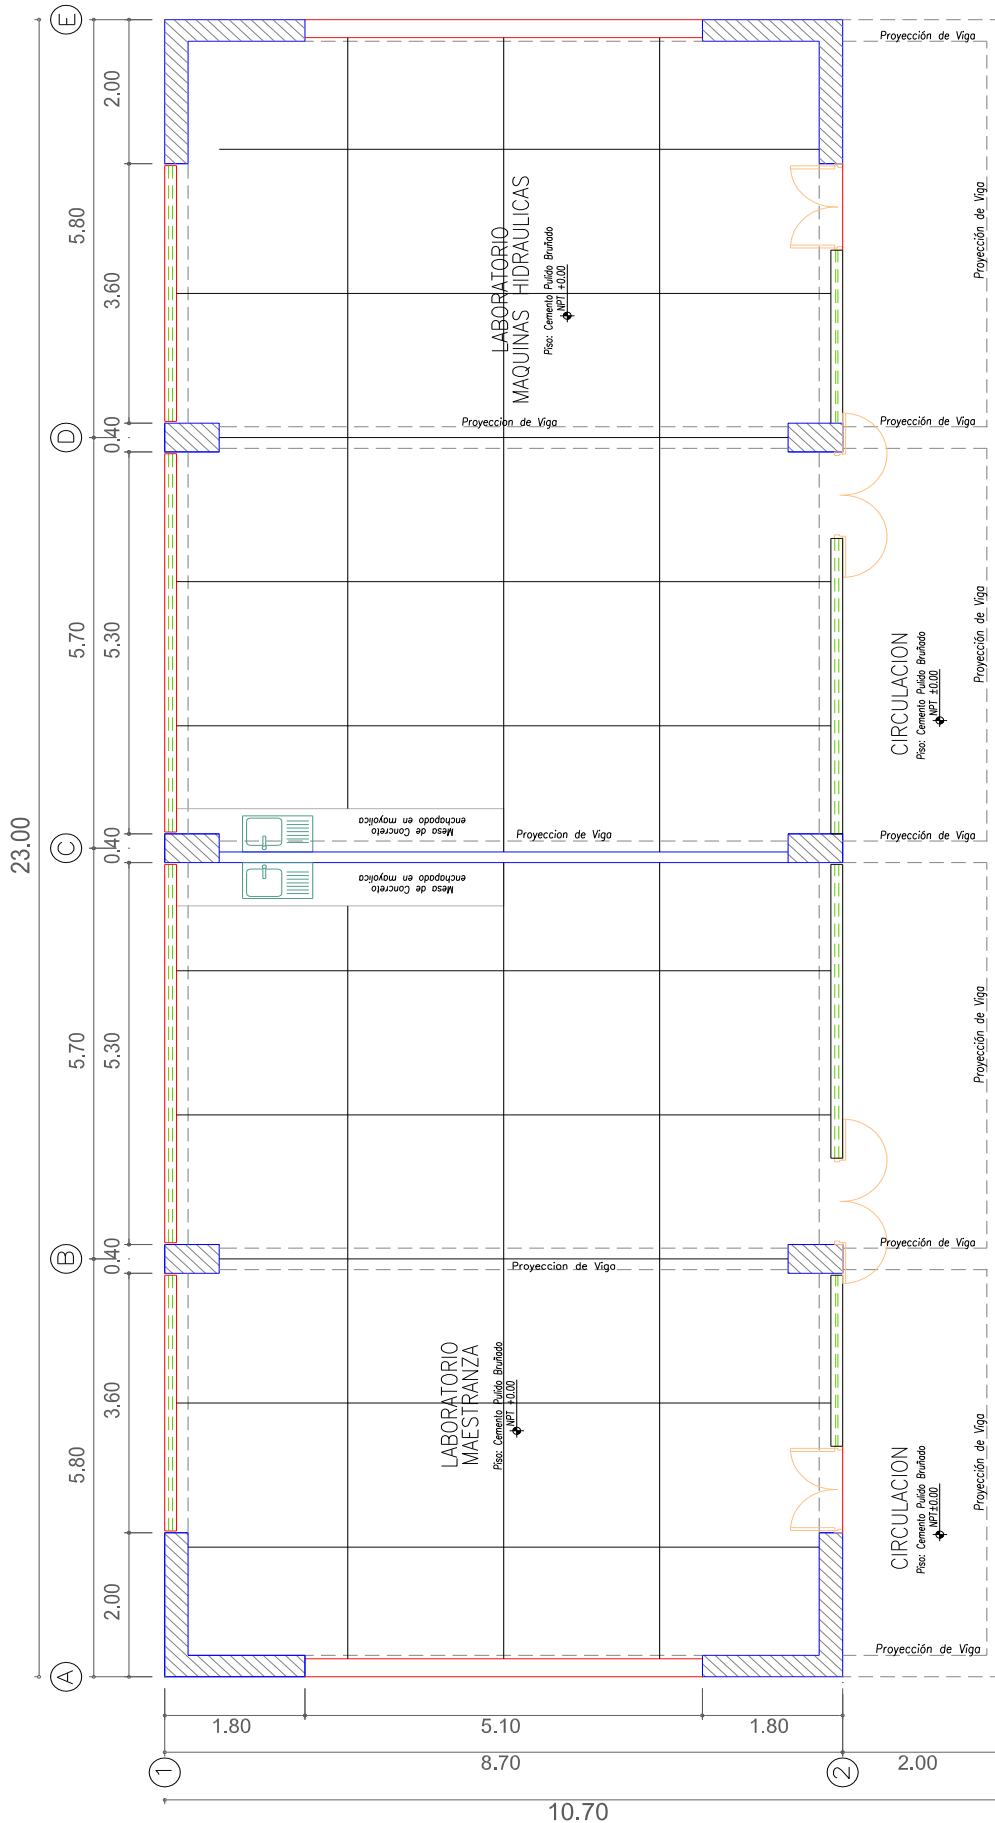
a. Planta arquitectónica del primer nivel edificio convencional.
